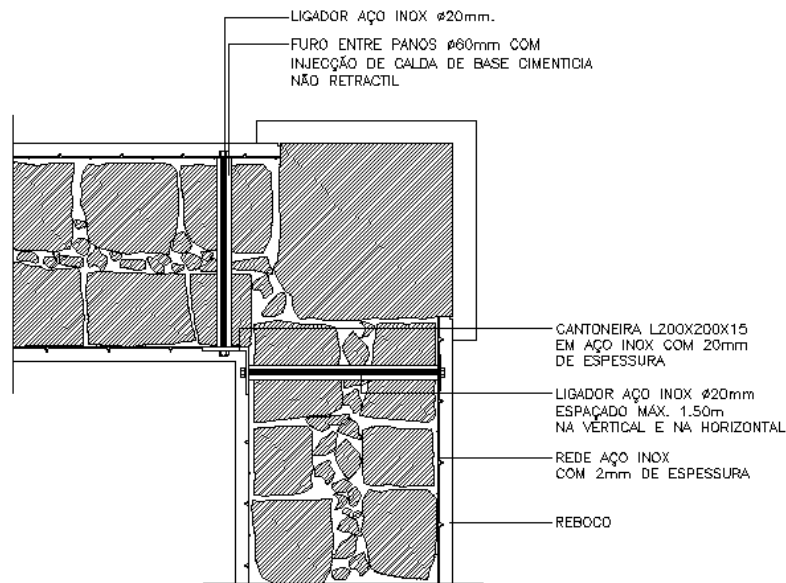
Corte horizontal do pormenor de reforço das paredes com estrutura metálica, na zona das cantarias [32].
